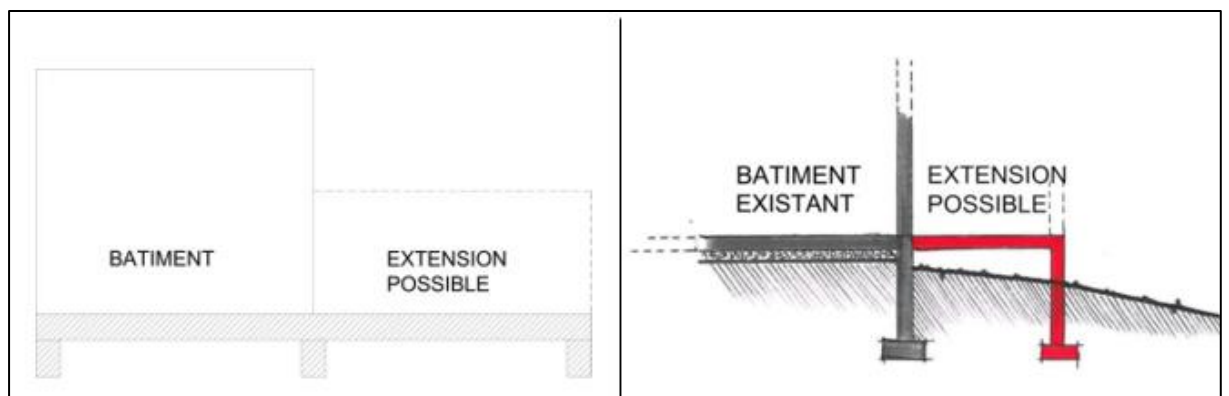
Possibilité d'extension d'un bâtiment selon fondation
